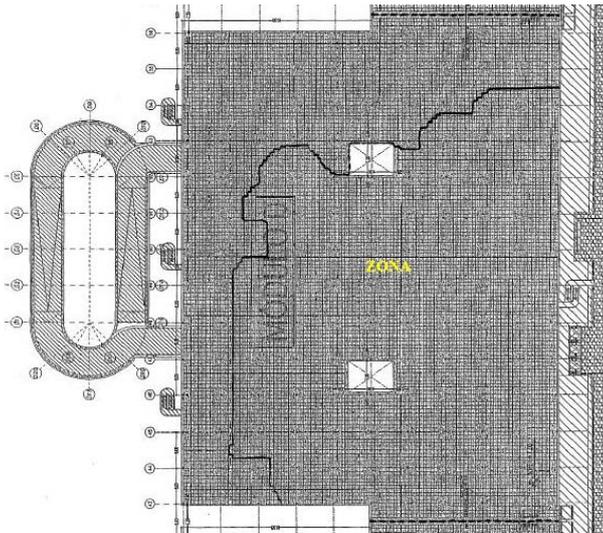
Izquierda: Zona de forjado hundida en techo de planta 1.
